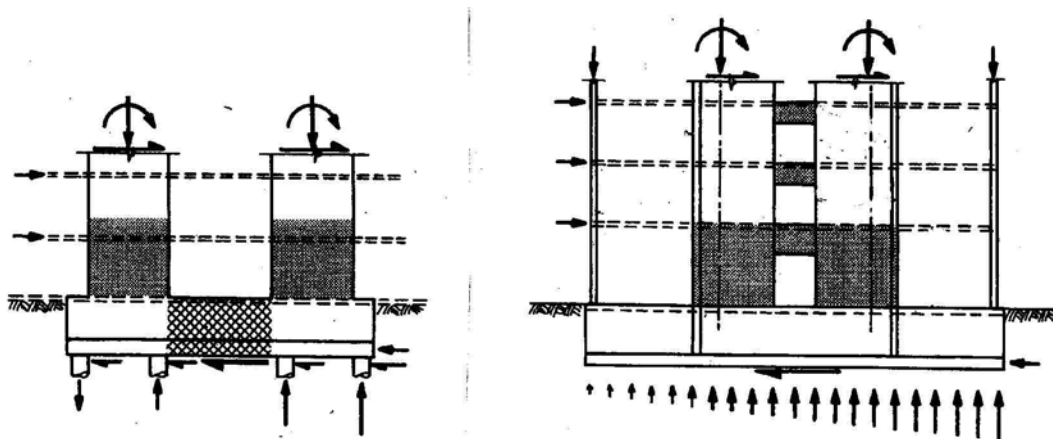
Fondation combinée de 2 voiles de contreventement par des poutres de couplage. A gauche, fondation sur pieu. A droite, fondation directe. [Paulay, 1992.]
